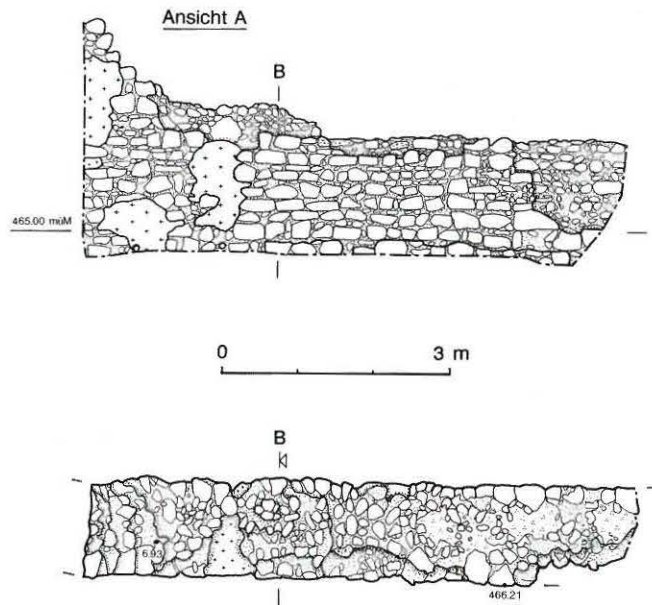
Stadtmauer. Ansicht, Grundriss und Schnitt. M. 1:100.
